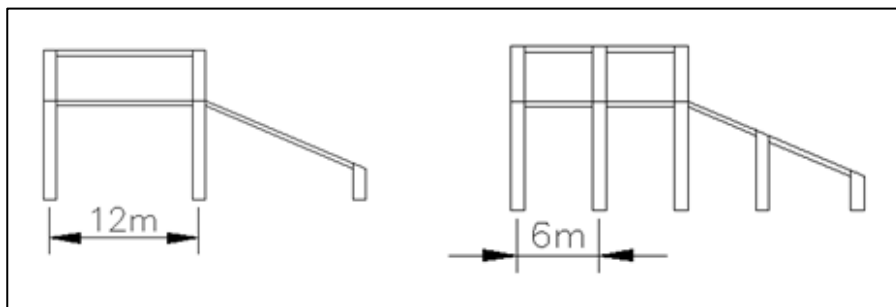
Cambio en la geometría de los pórticos estructurales.
